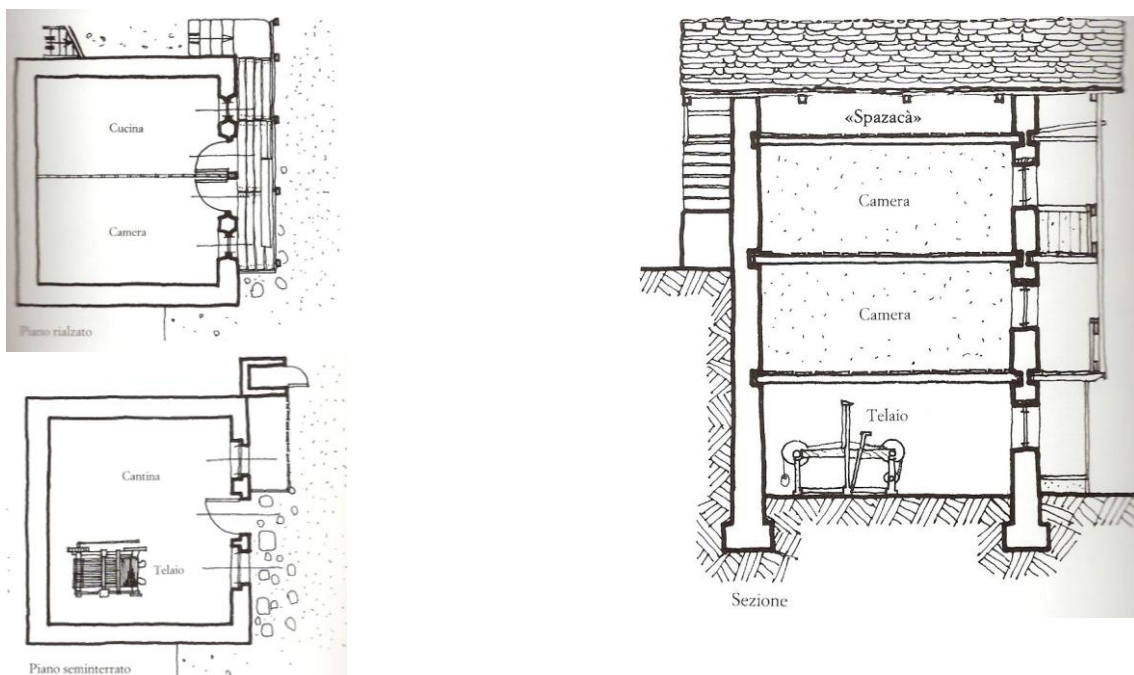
Pianta e sezione di un edificio tipo del Terziere di Mezzo
